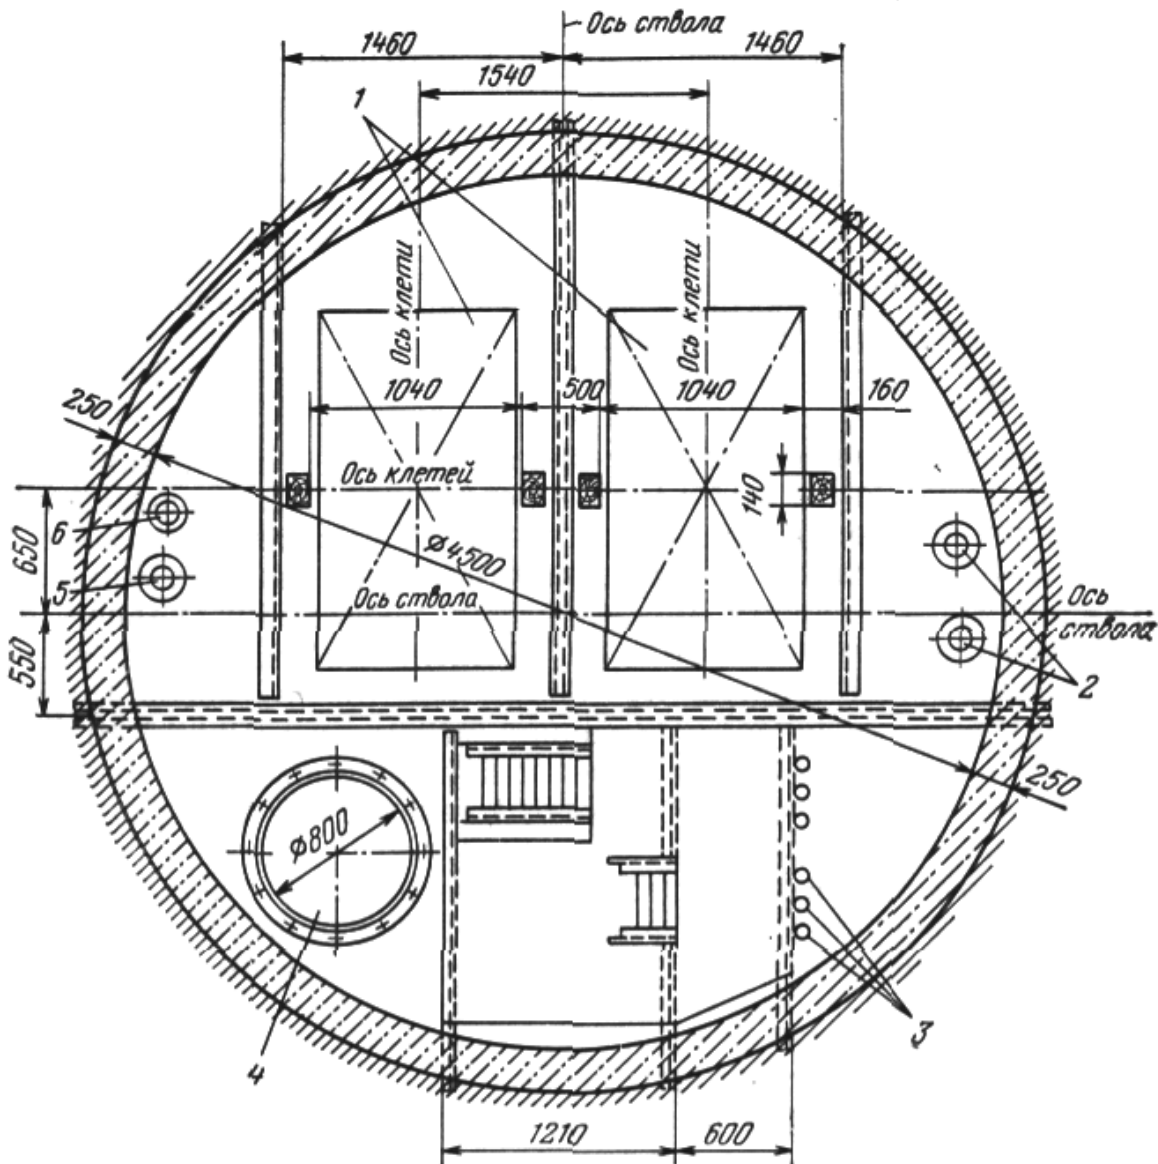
Типовое круглое сечение ствола разведочной шахты диаметром 4,5 м: 1 – шахтные клетки; 2 – трубы для водоотлива; 3 – электрические кабели; 4 – вентиляционный трубопровод; 5 – труба для подачи сжатого воздуха; 6 – трубопровод водоснабжения
